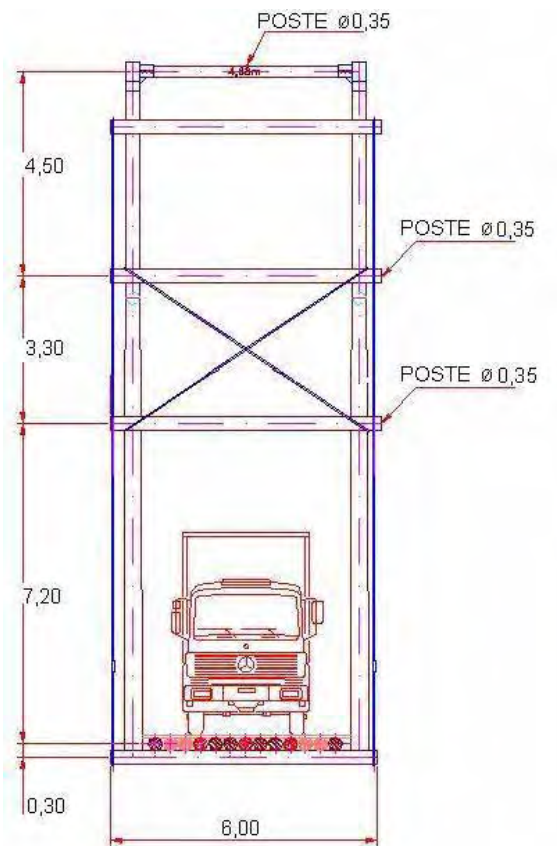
Detalhe dos contraventamento ao longo da altura do pórtico.
